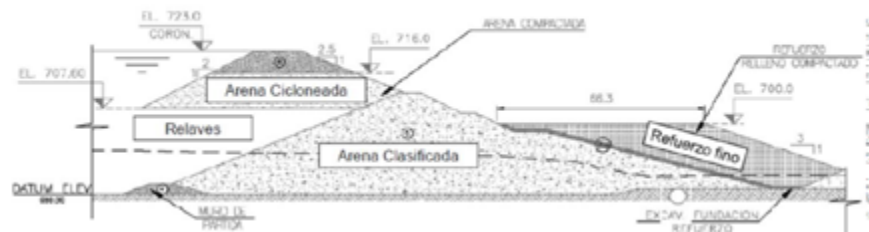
Sección transversal muro 4B del tranque Cauquenes
